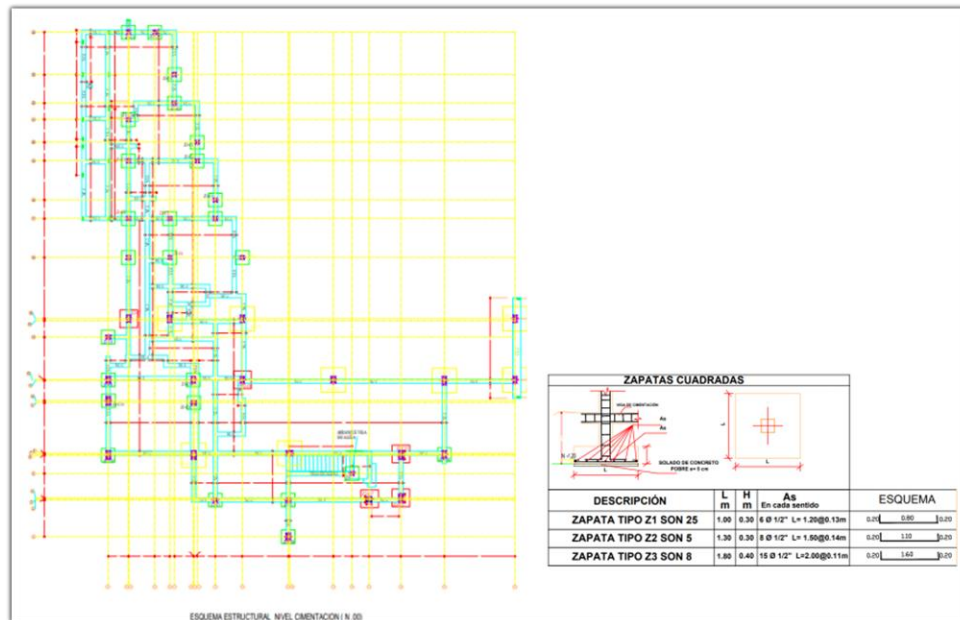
Cimentación. Fuente: Planos AutoCAD.
